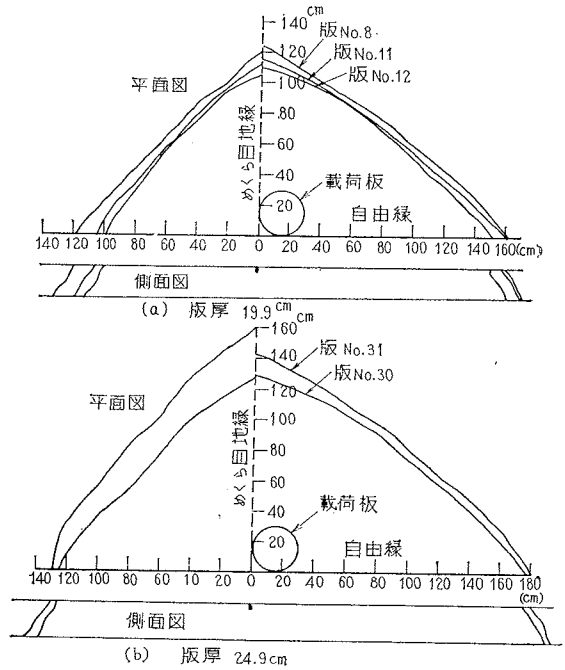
コンクリート版めくら目地隅角におけるひびわれ発生位置
